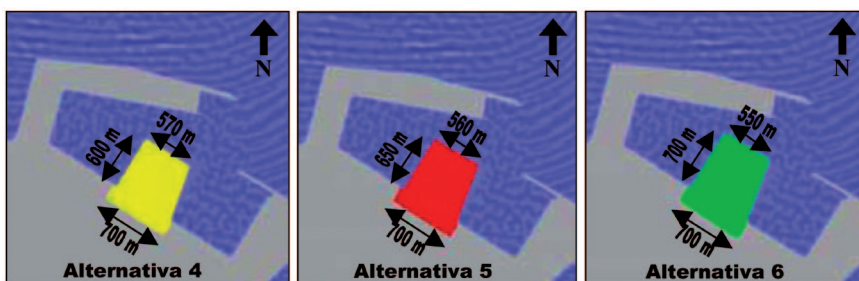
Disposición en planta de las Alternativas 4, 5 y 6 (forma trapecial).
